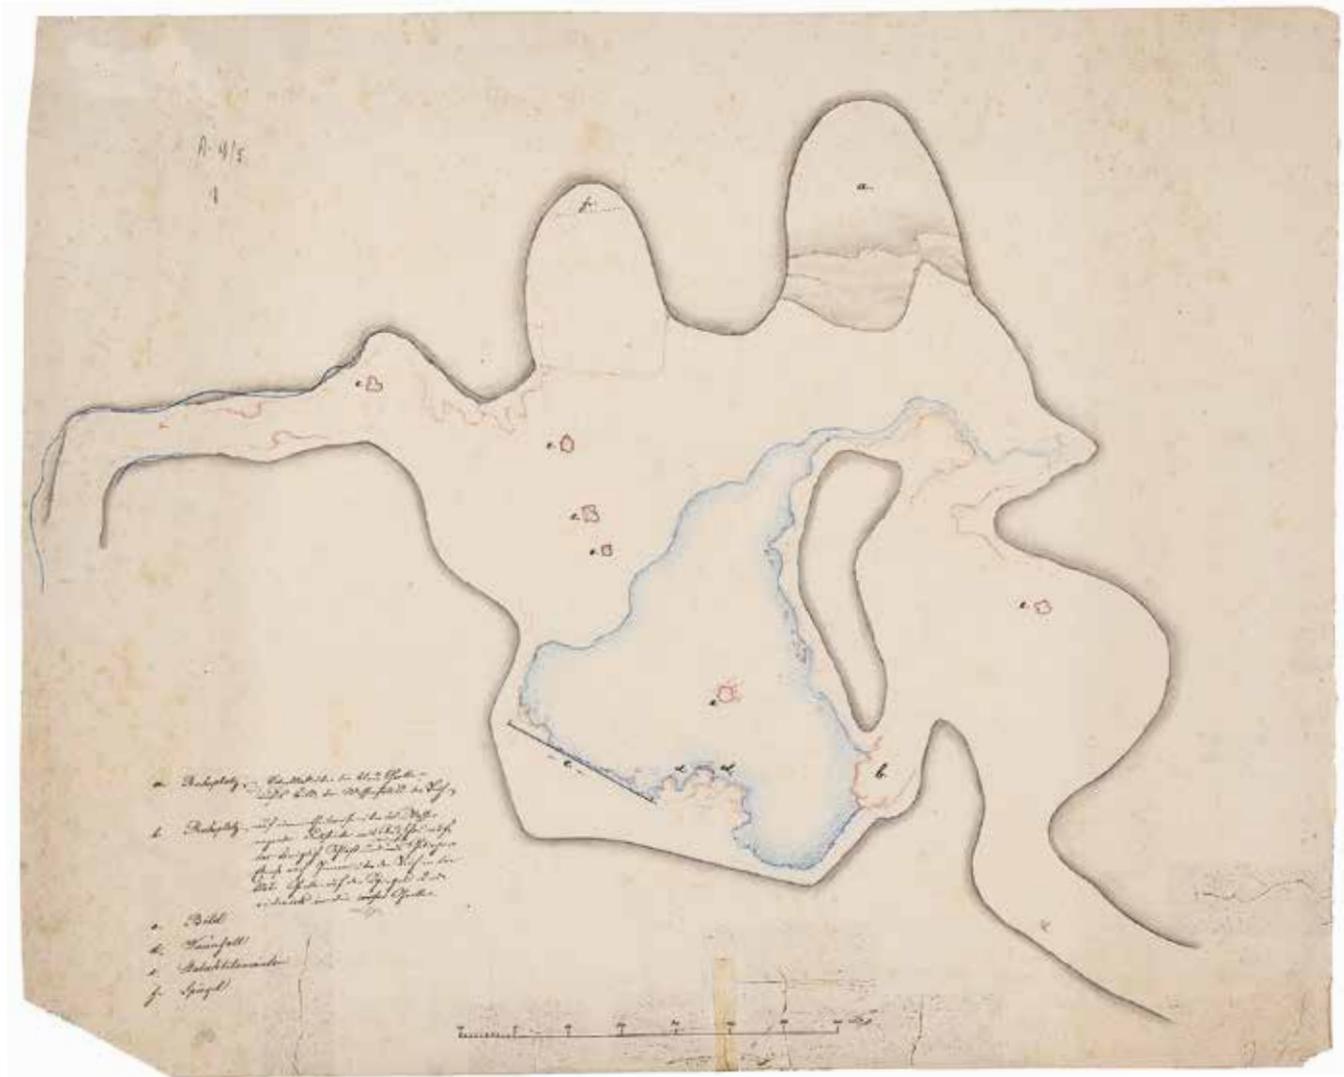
Grundriss der Venusgrotte, ca. 1876, BSV, Plansammlung der Gartenabteilung, Inv.-Nr. LI-01-05-6
